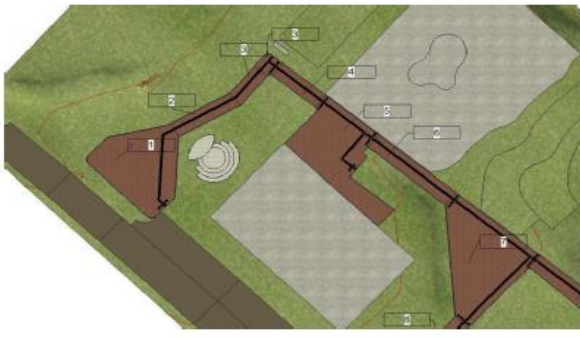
Plano Topográfico planta del predio a intervenir, Fuente: Contratista
